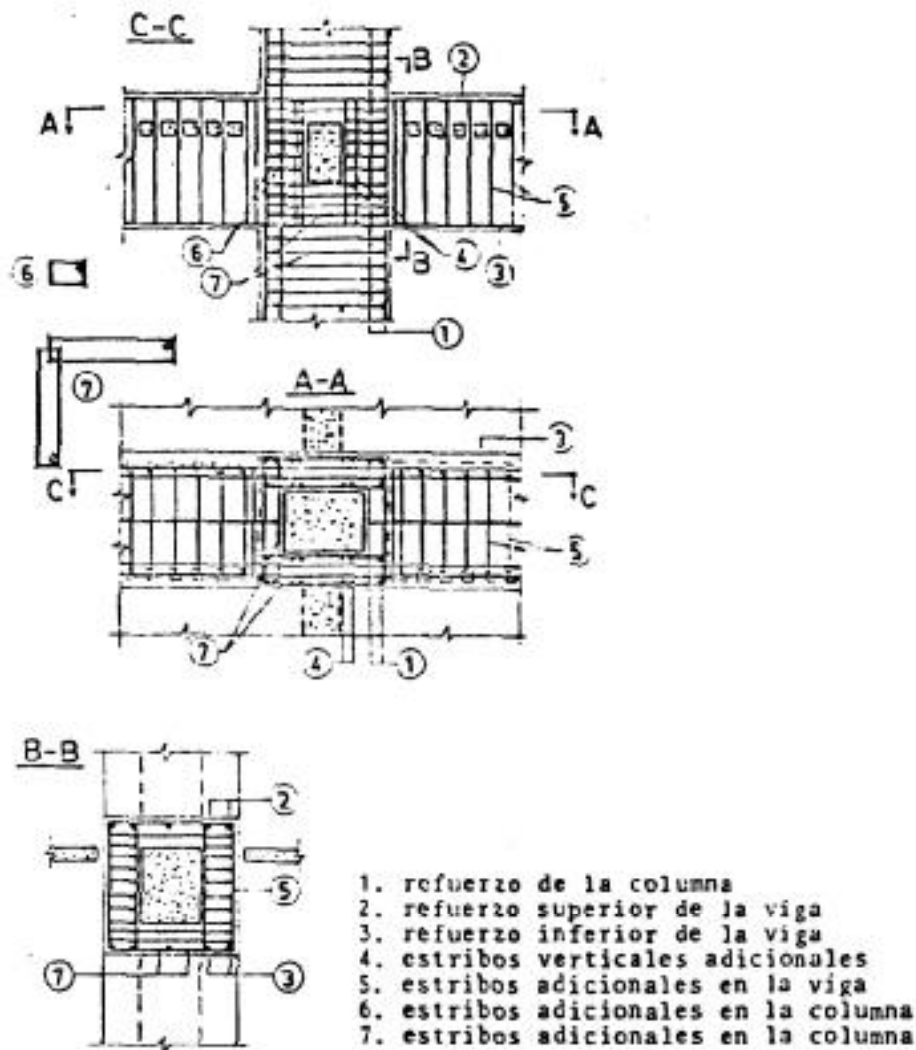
Encamisado completo viga-columna-nudo (ref. 1)
